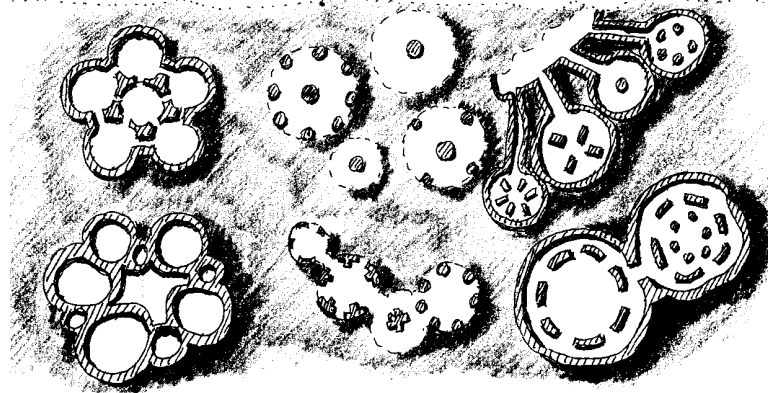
Contoh ilustrasi dan penerapan historis penjumlahan bangunan atau bagian bangunan
